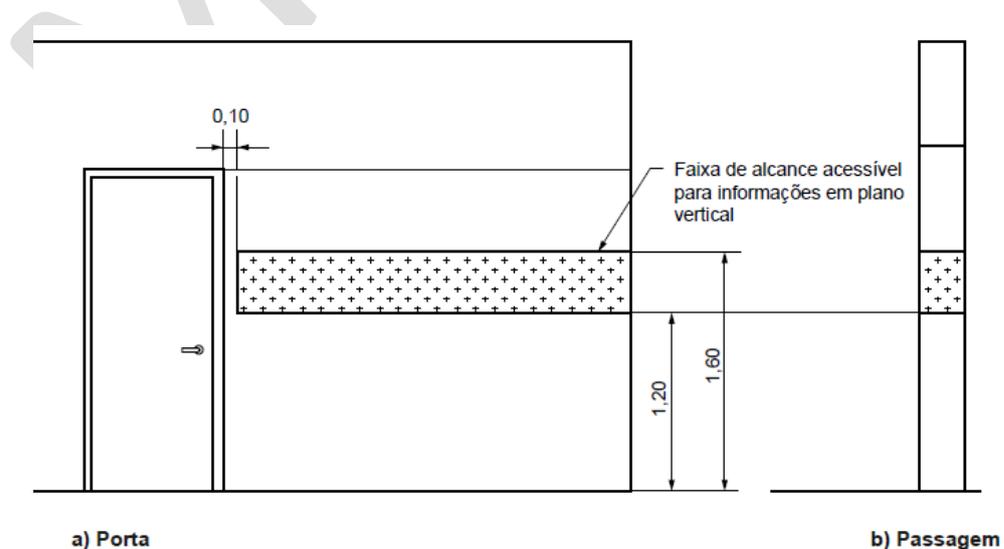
Sinalização de portas e passagens – Faixa de alcance acessível
